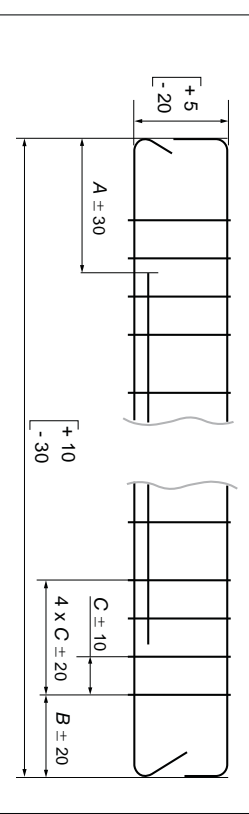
norme NF A 35027 - tolérances sur les caractéristiques dimensionnelles des armatures assemblées.
